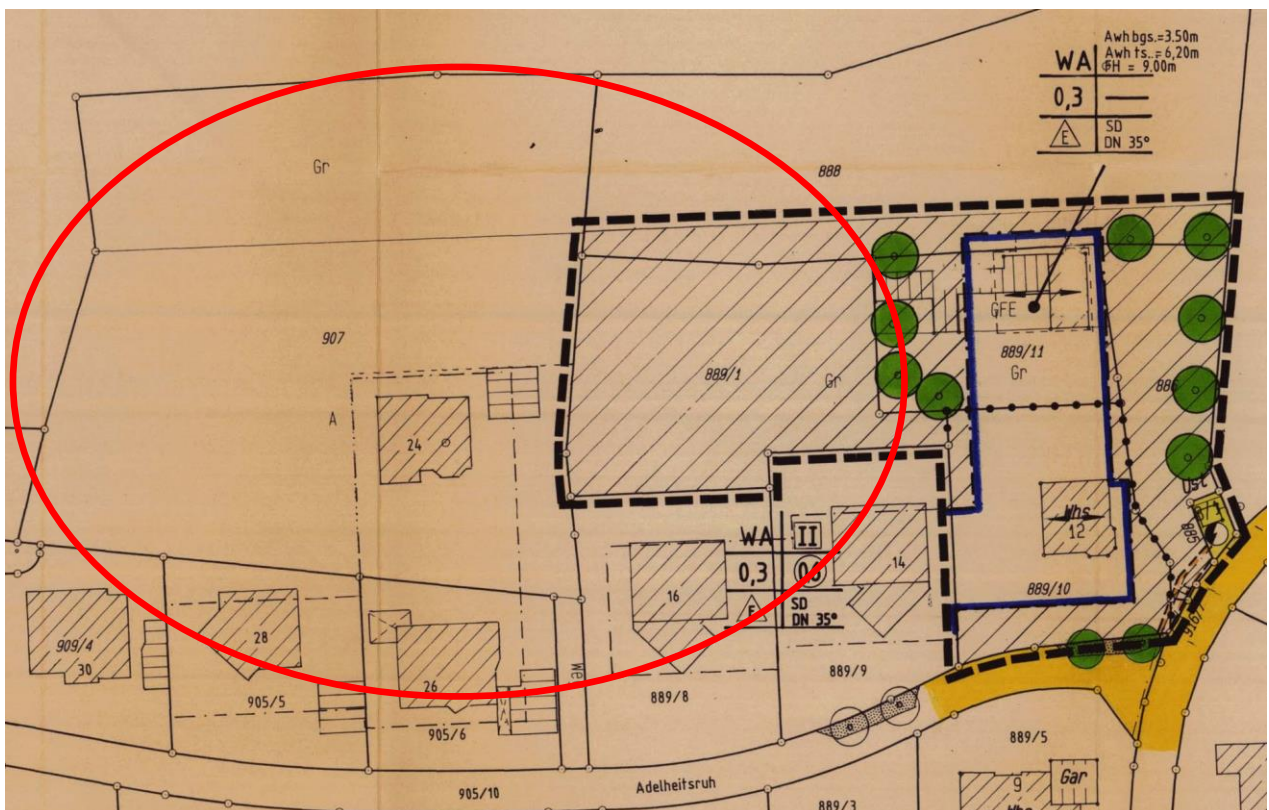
Ausschnitt Bebauungsplan „Hochweg 1. Änderung“ (1996c), Plangebiet rot umrandet, unmaßstäblich
